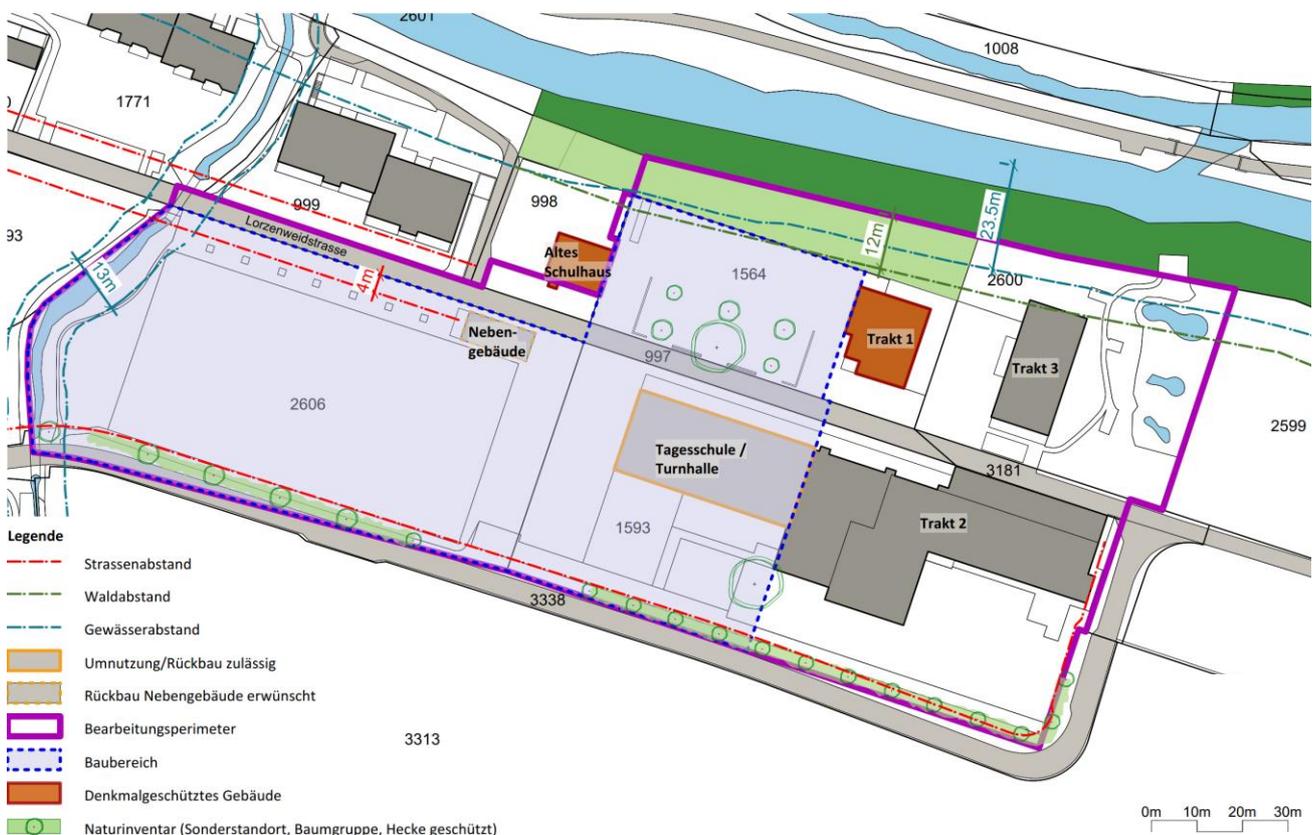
Infoplan mit Bearbeitungsperimeter (violett) und Baubereich (blau gepunktet)
